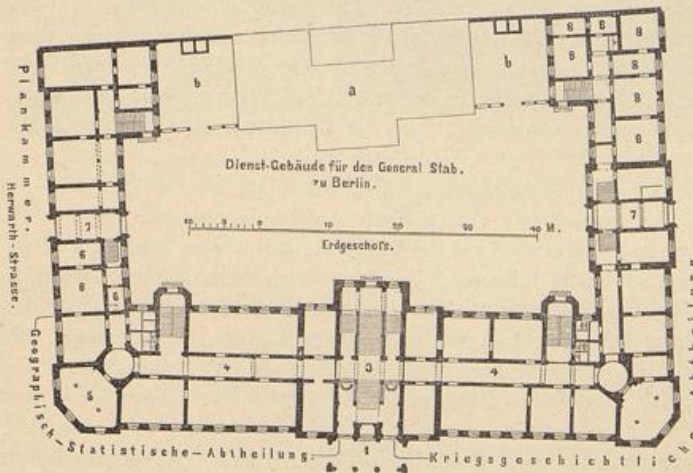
Grundriss vom Erdgeschoss.
